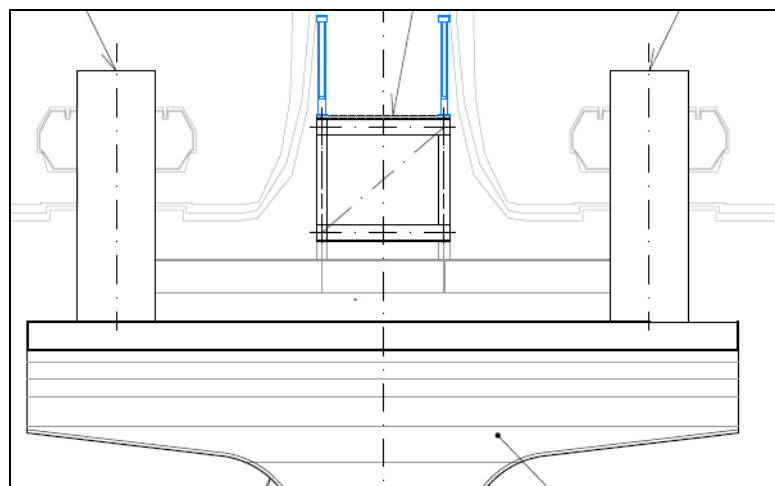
Detalhe da viga apoiada na travessa.
